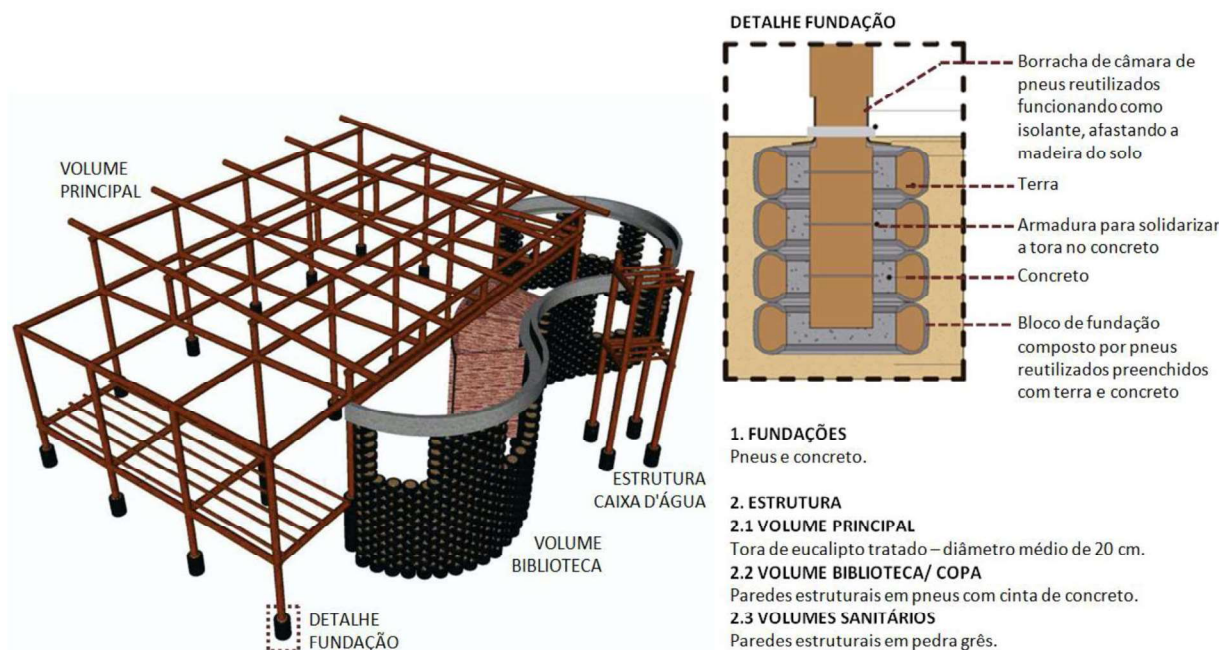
Representação esquemática do sistema estrutural e detalhe da fundação.
